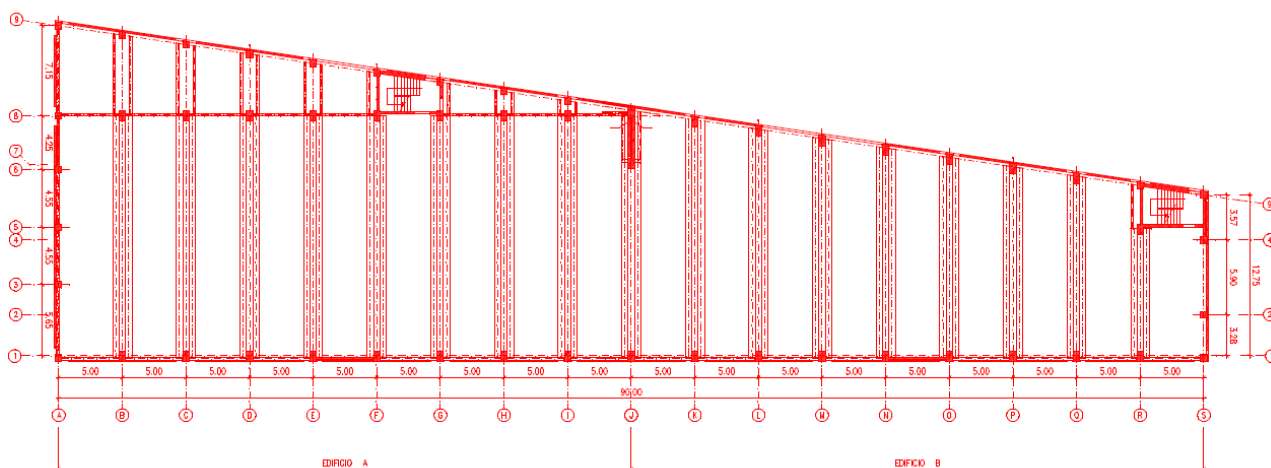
Planta da estrutura dos pisos 2, 3 e 4
